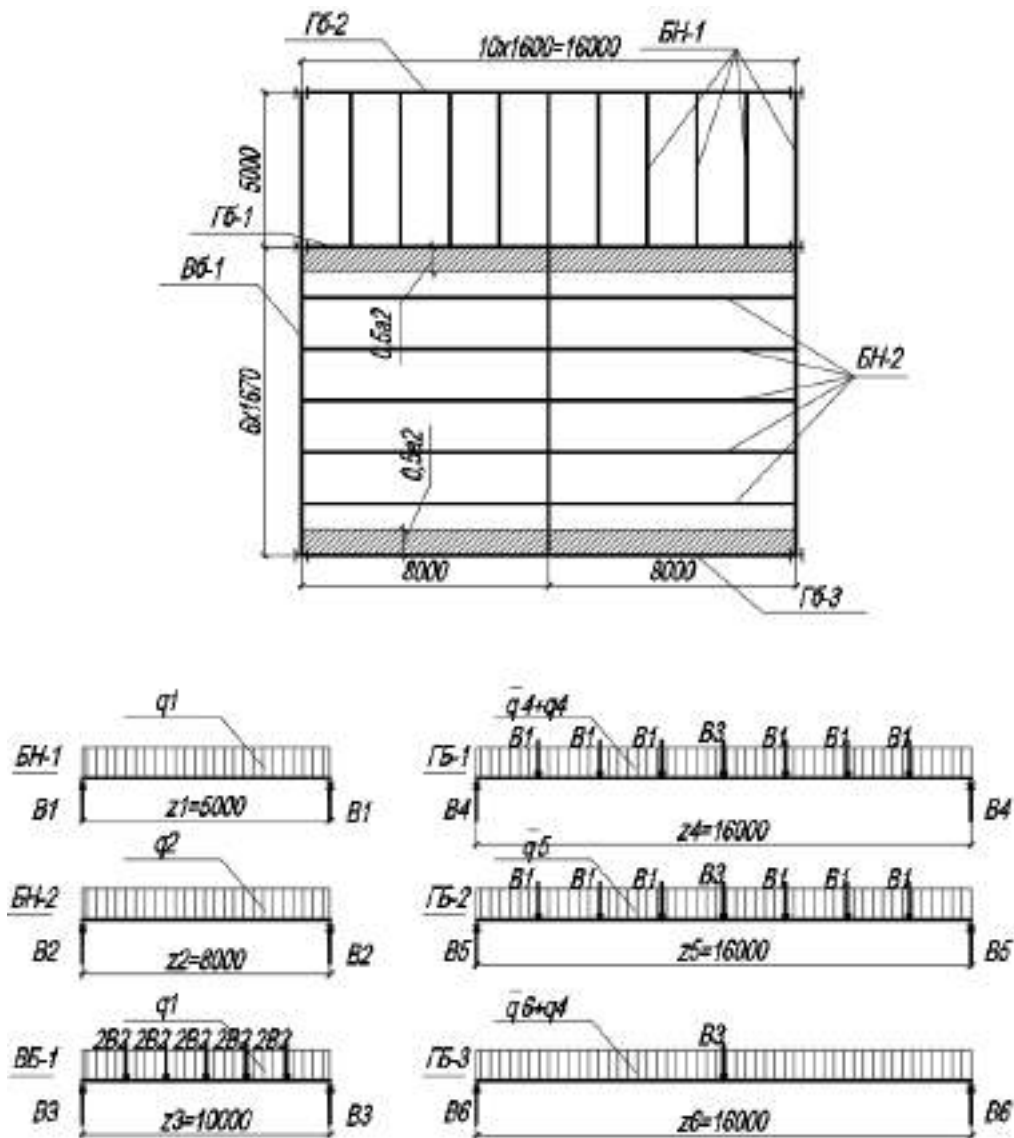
Конструктивная схема балочной клетки 1 и 2 вариантов и расчетной схемы балок настила БН-1, БН-2, вспомогательной ВБ-1 и главных балок ГБ-1, ГБ-2, ГБ-3
